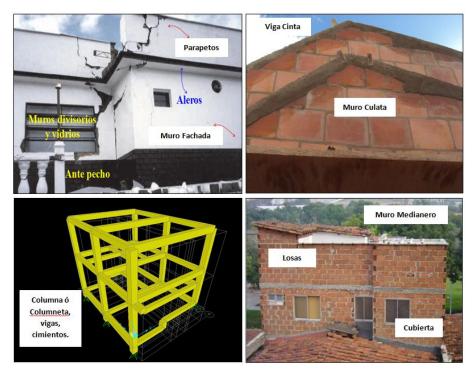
Componentes estructurales y no estructurales típicos que conforman una vivienda popular en la ciudad de Bogotá. Fuente: Elaboración propia (algunas fotos son tomadas de la pagina web del FOPAE).
